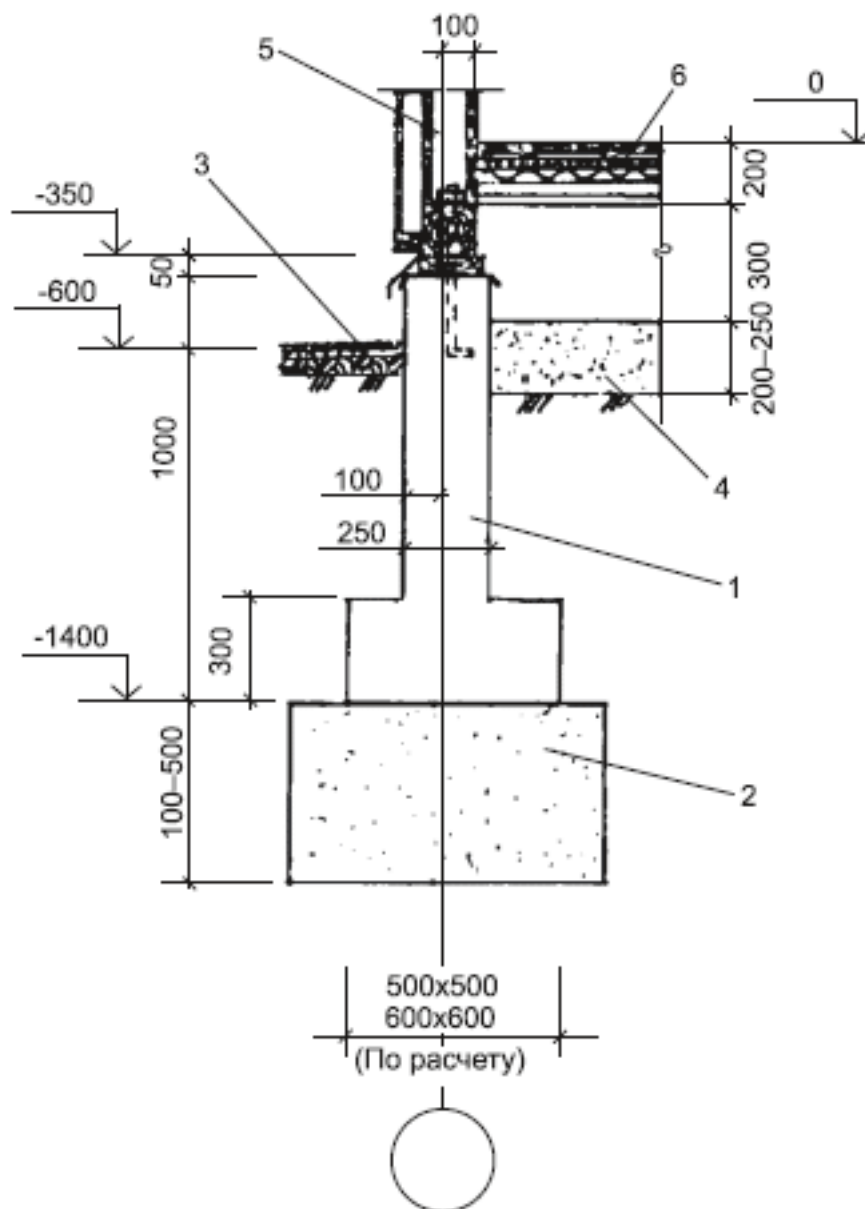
Столбчатый железобетонный фундамент: 1 – железобетонный монолитный столбчатый фундамент; 2 – подушка из среднезернистого песка; 3 – отмостка; 4 – слой уплотненного песчаного грунта; 5 – каркасная стена; 6 – цокольное перекрытие с дощатым полом
